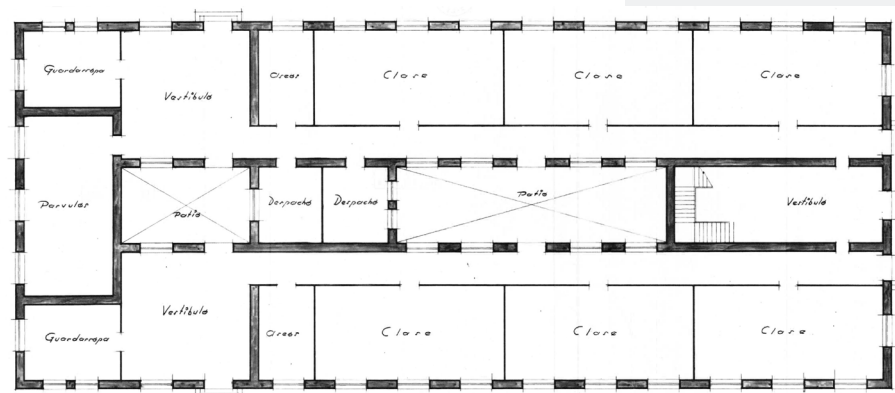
, Planta Baja. Proyecto 1951, Antonio Serrano Peral
